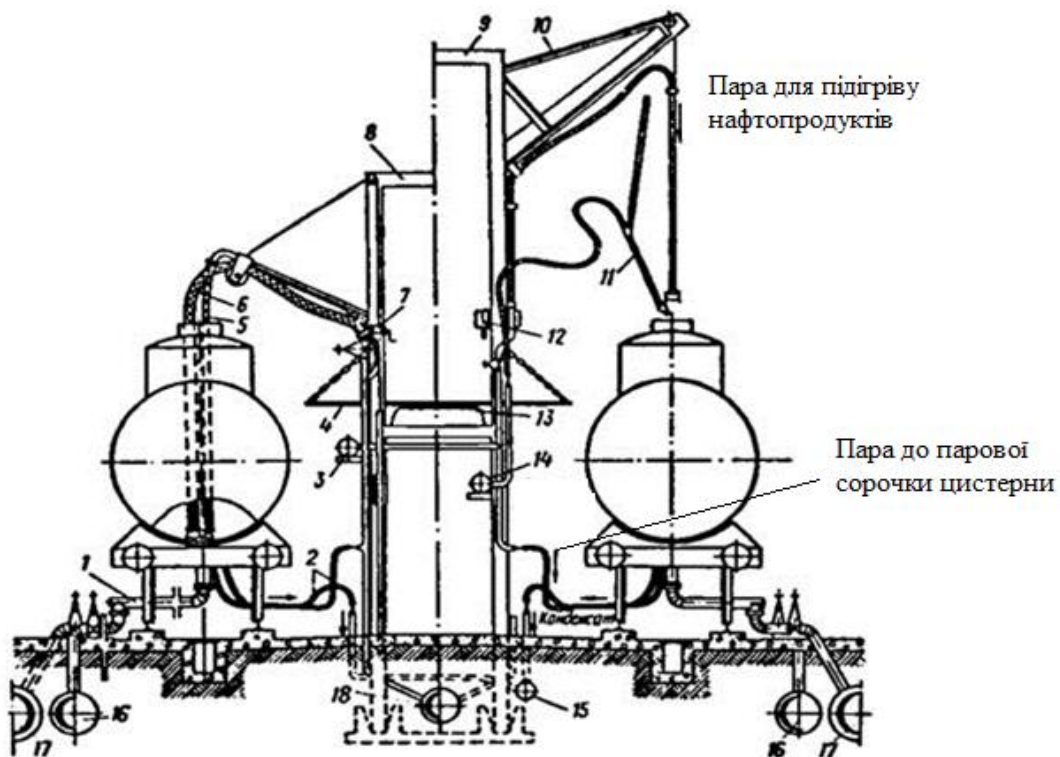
Естакада для маршрутного зливу нафти і дизельного палива: 1 – зливний пристрій; 2 – рукава для подачі пари і відведення конденсату; 3 – колектор пари; 4 – відкидний місток; 5 – рукав для зачистки; 6 – зливний рукав; 7 – підйомно-поворотний пристрій; 8 і 9 – рами; 10 – укосина; 11 – апарат гідравлічного розмиву; 12 – лебідка; 13 – плита; 14 – колектор підігрітої нафти; 15 – колектор конденсату; 16 – труба нижнього зливу дизельного палива; 17 – труба зливу нафти; 18 – труба верхнього зливу дизельного палива
